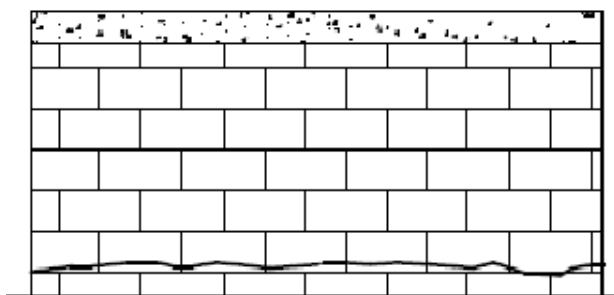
Fissuração horizontal na base da alvenaria por movimentações higroscópicas diferenciadas
